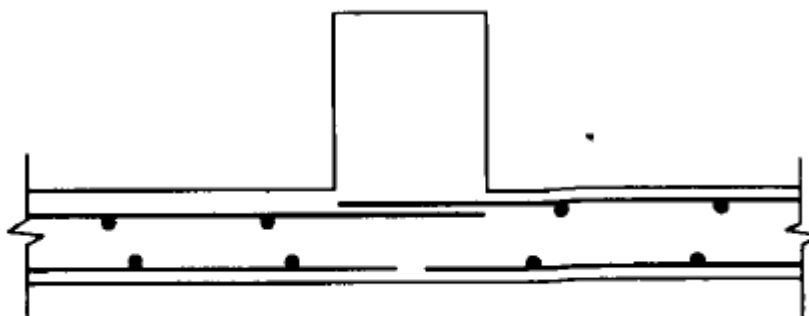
钢筋焊接网在反梁的布置
